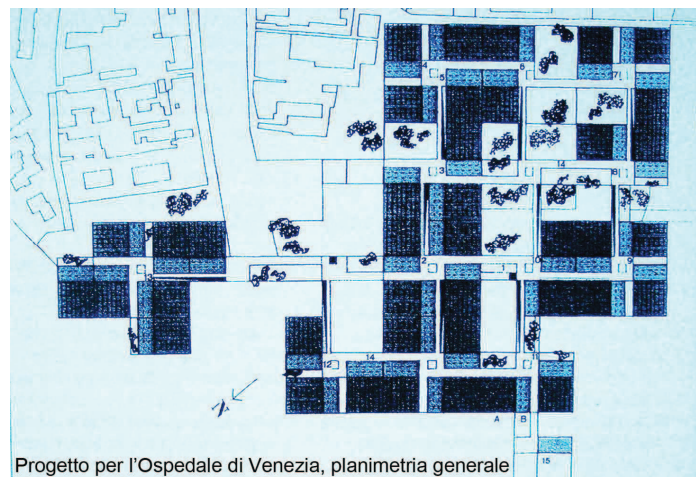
Planimetria generale, progetto per l'Ospedale di Venezia.
